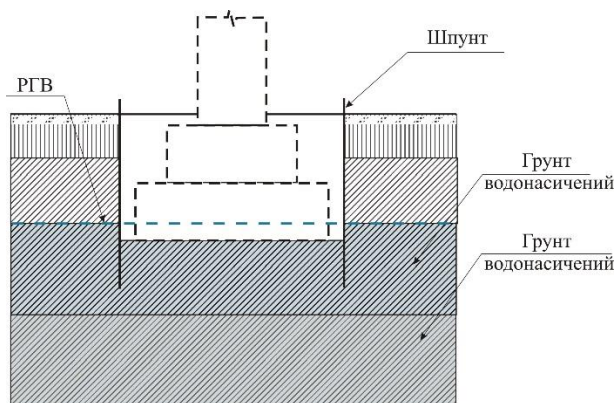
Схема котловану з рівнем ґрунтових вод вище дна котловану та забитим шпунтом
